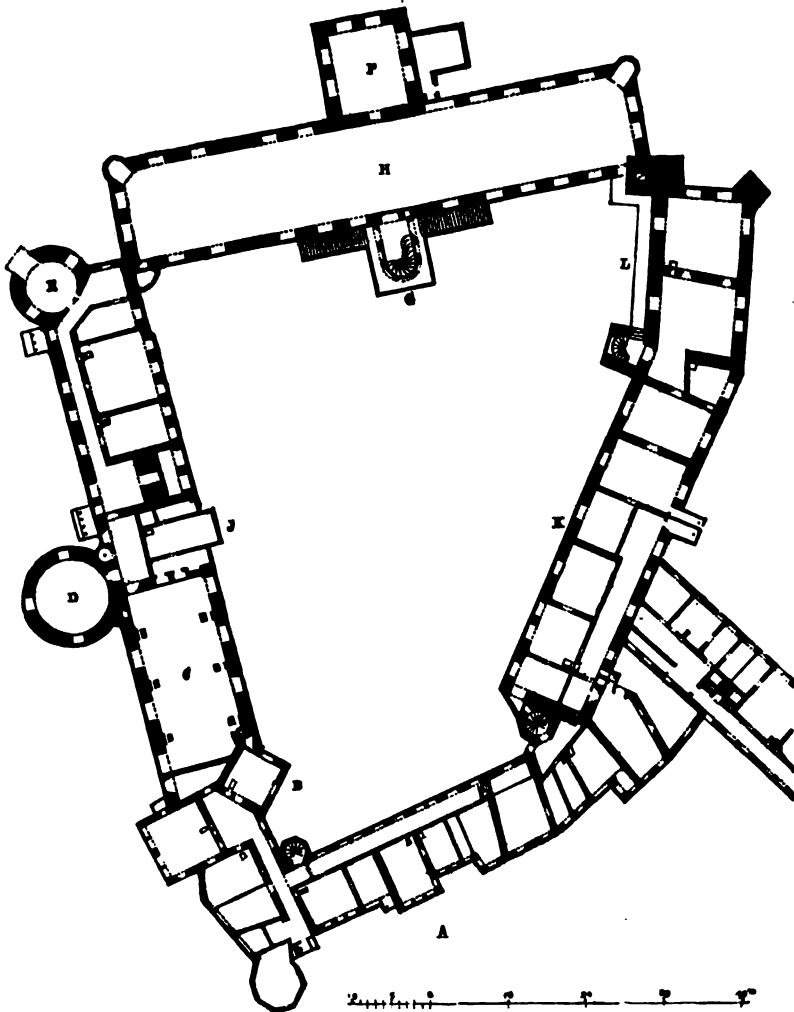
Schloss zu Torgau. Grundriss des I. Stocks.
